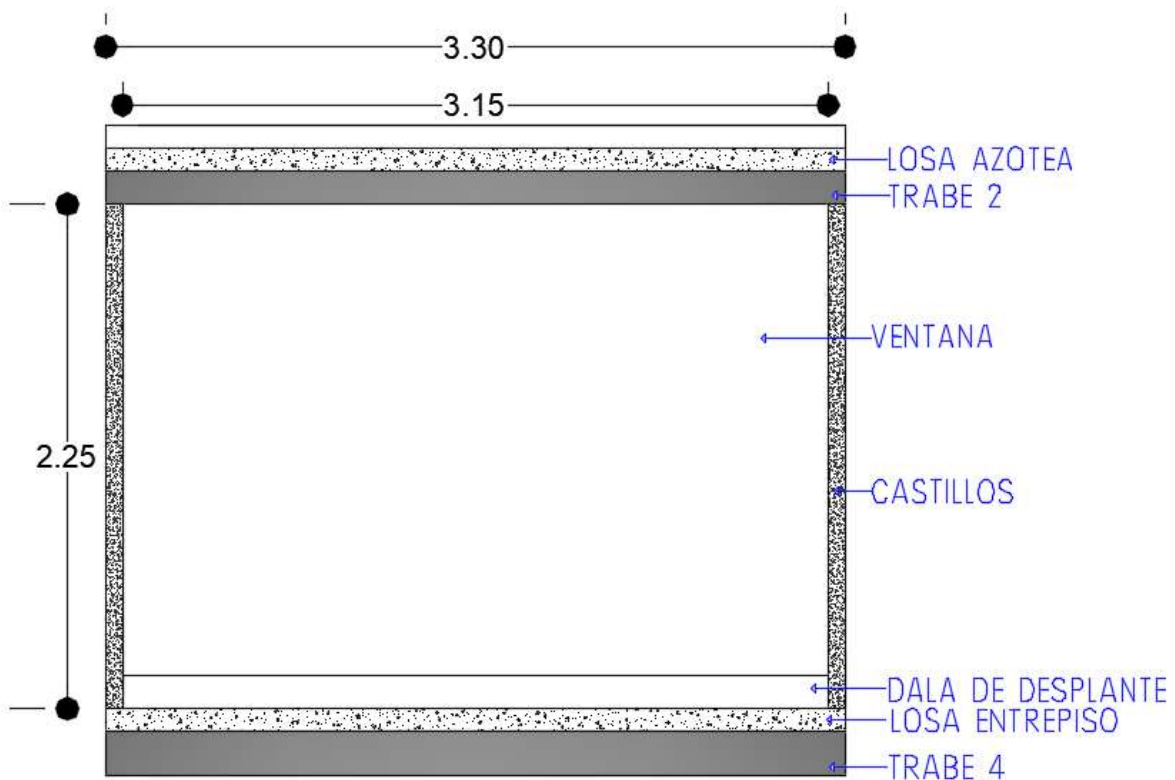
Muro que soporta la trabe No. 4 de la losa de entrepiso
